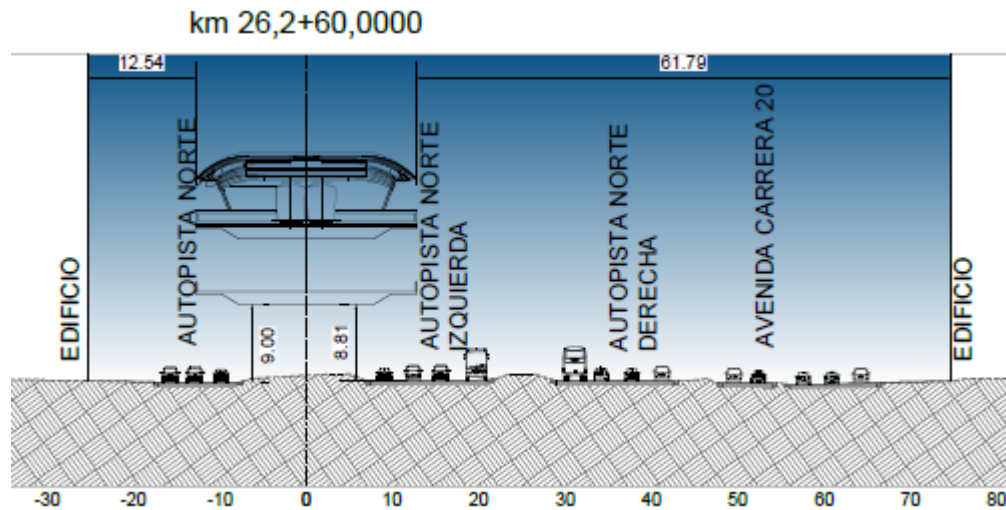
Sección transversal en vía elevada PK 26+060
